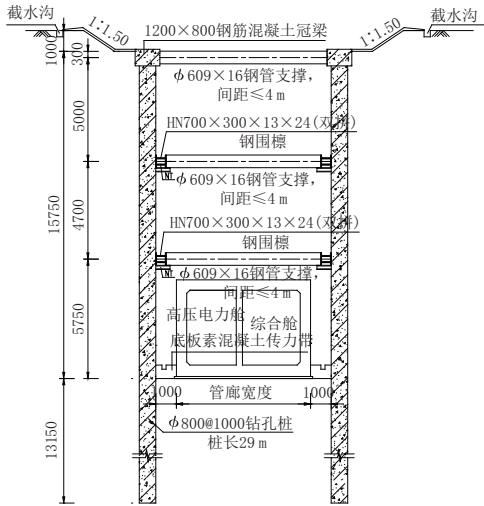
明挖法管廊标准段基坑支护断面图(单位:mm)
